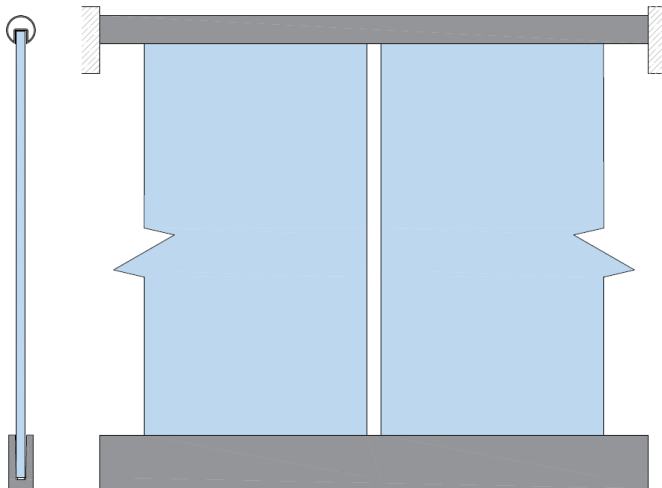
Variante γ : Ausführung mit durchgehendem Handlauf und seitlicher Endanbindung des Handlaufs
